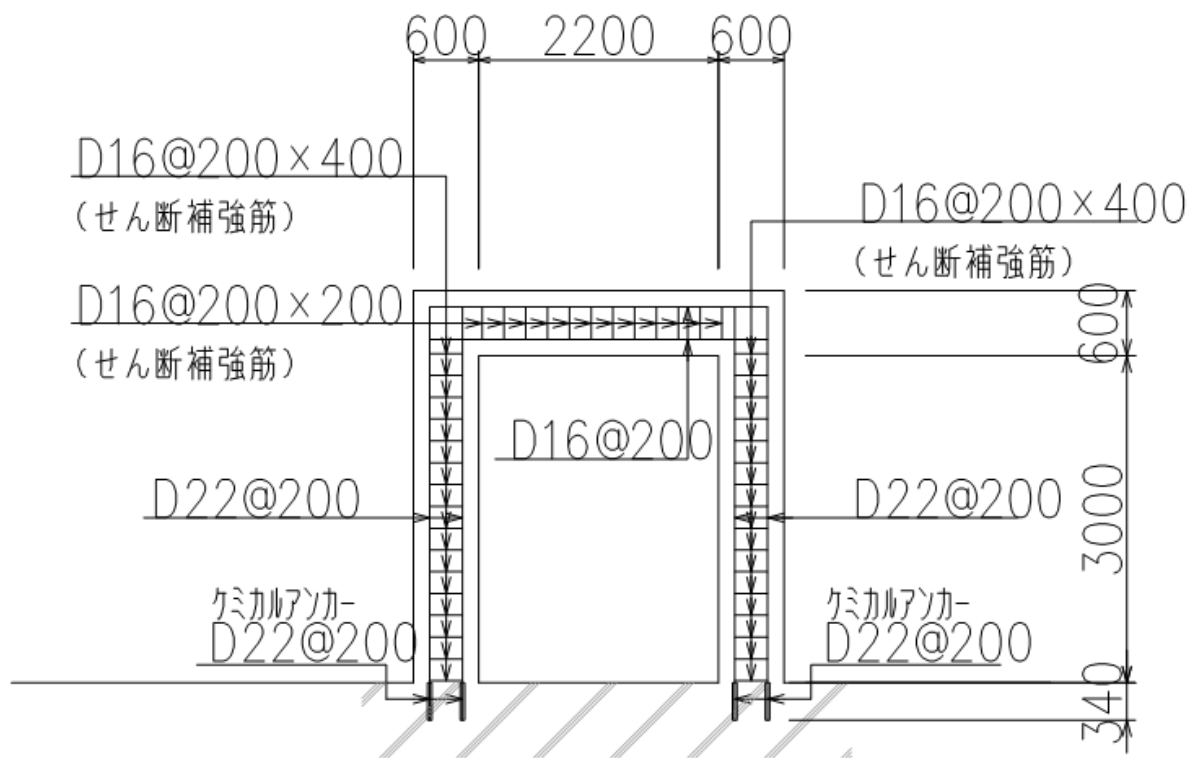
ポンベ庫 概略配筋図 (A-A 断面)
